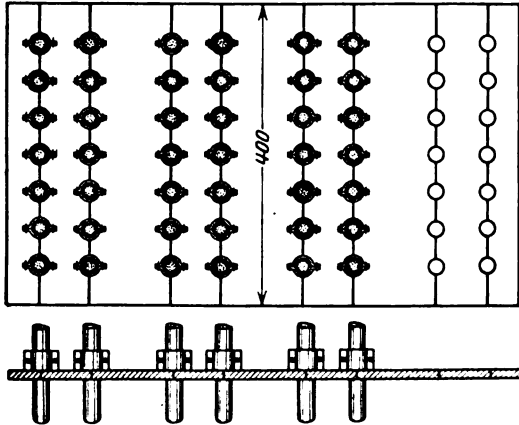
Kabelbefestigung mit Schellen, die auf ausgeschnittenen Eisenplatten ruhen.
